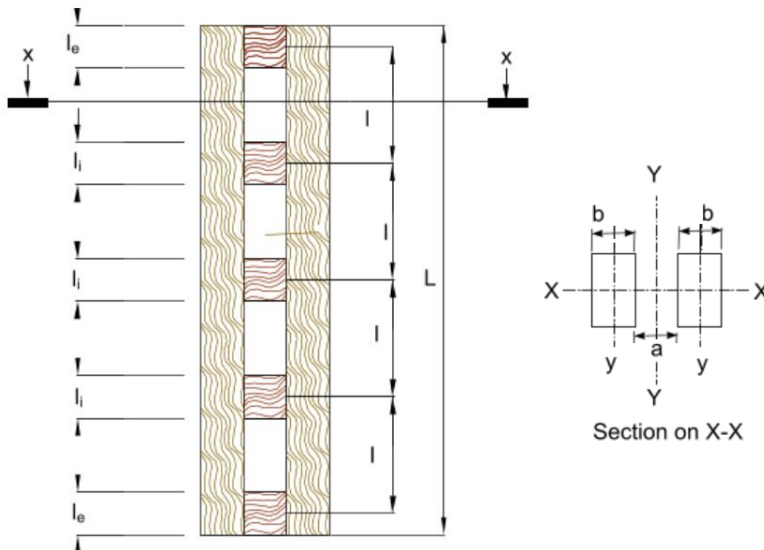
Sambungan kolom berspasi dan balok
